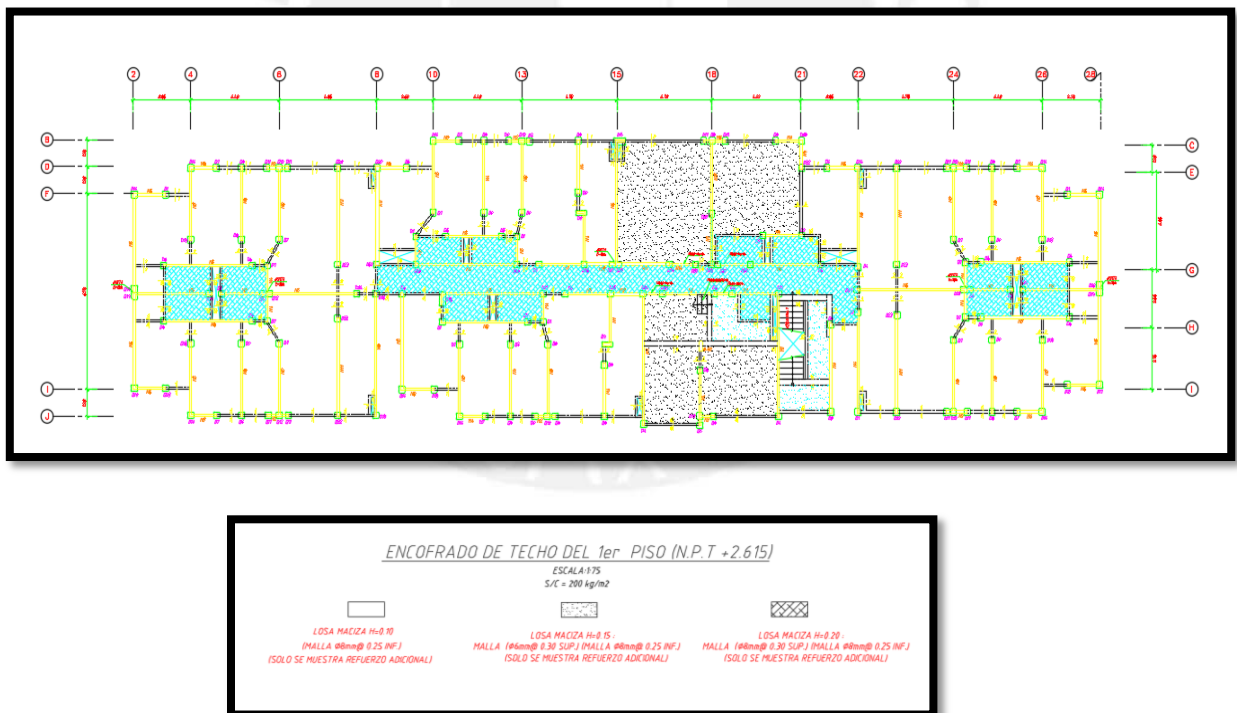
ESQUEMA DE ENCOFRADO PARA PRIMERA PLANTA
